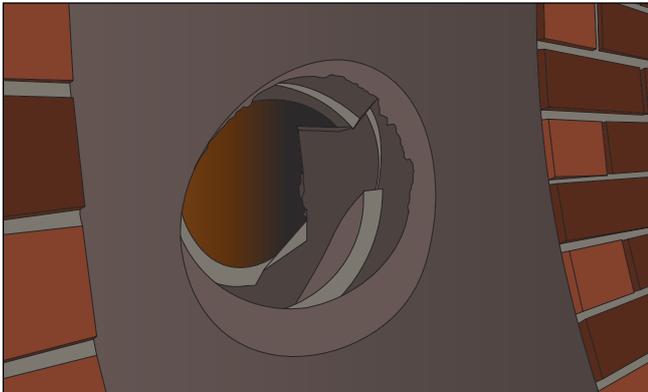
Ilustrações de ligações de ramais em más condições estruturais (1)
